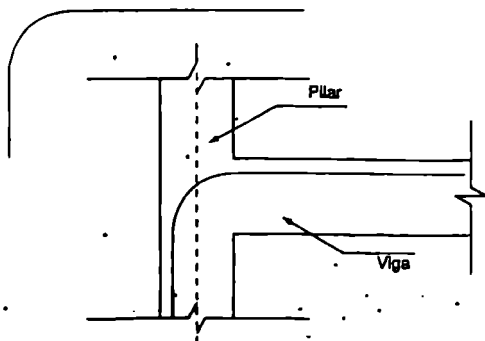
Armadura para combater o momento na viga na ligação com os pilares.
